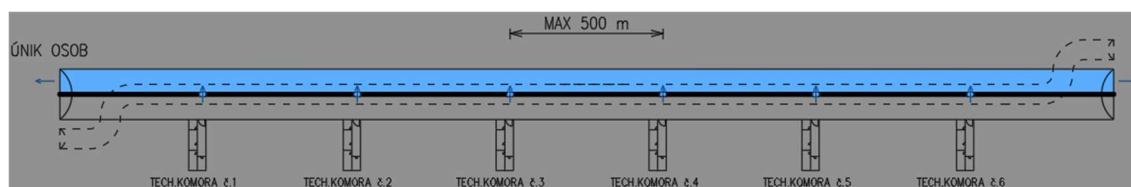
Schéma únikových cest Chotýčanského tunelu – Varianta 2
